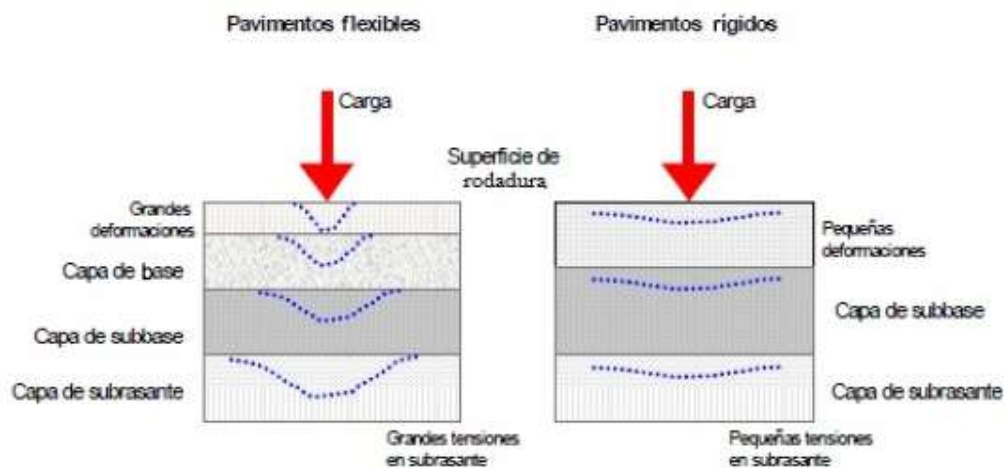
Estructura típica de pavimentos flexibles y rígidos.
